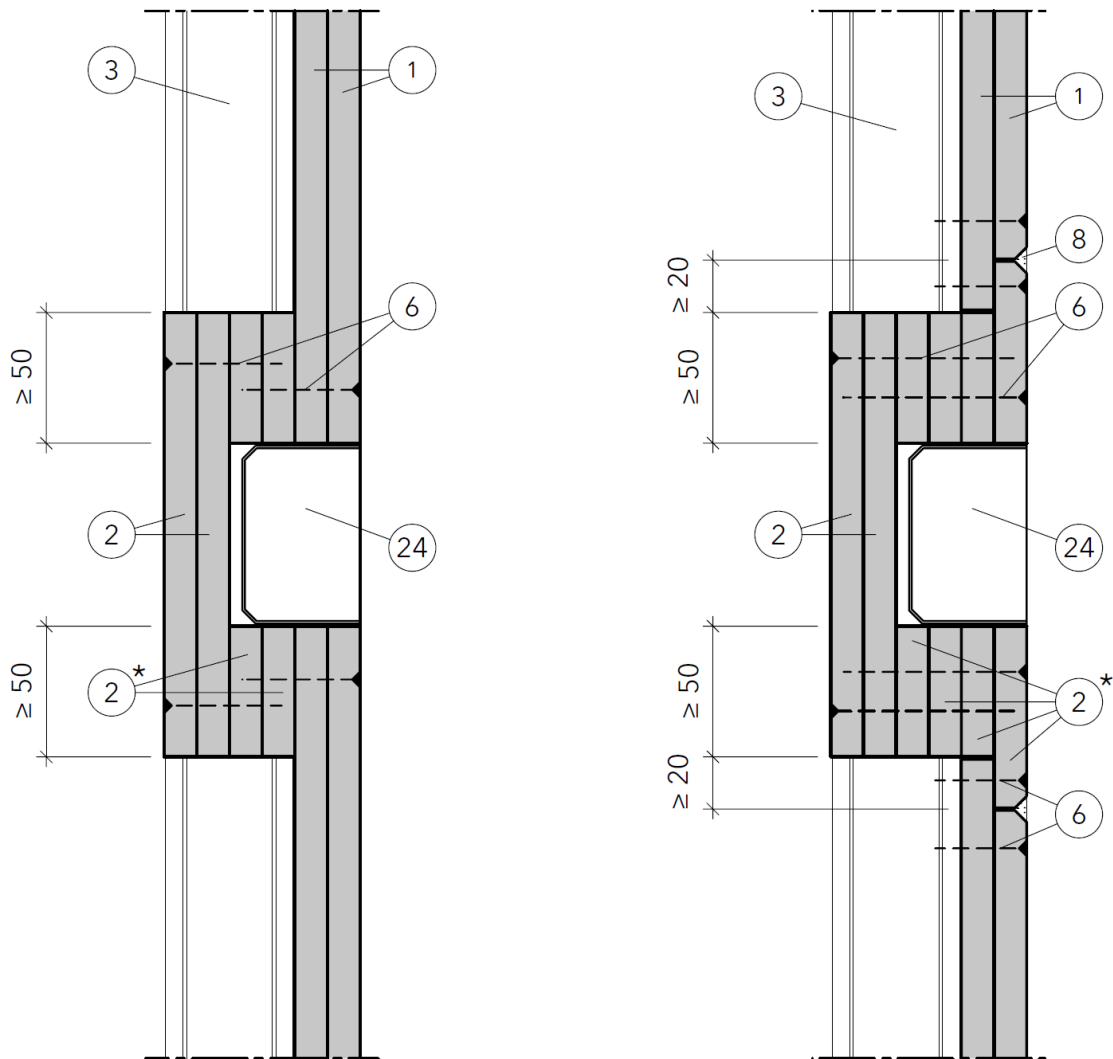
Dreiseitige Ausführung einer Schachtwand mit Anschluss an eine Massiv- bzw. Metallständerwand (Horizontalschnitt)
